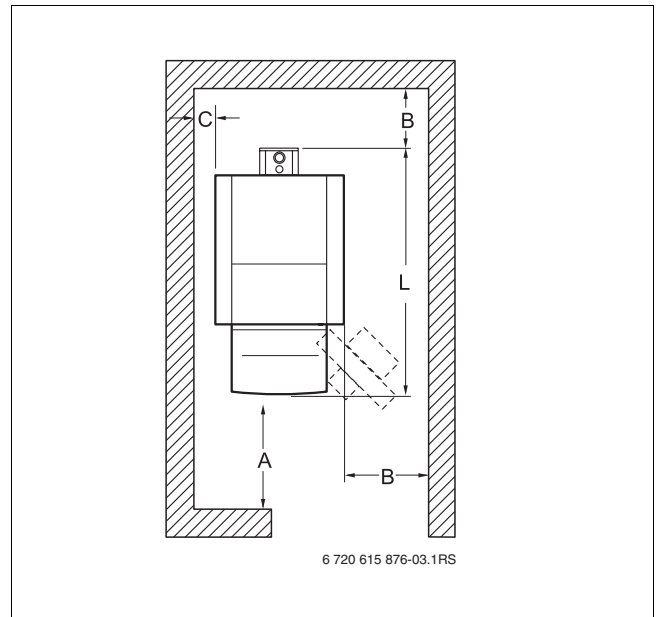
Distanze dalle pareti nel locale di posa (caldaia posizionata a destra o a sinistra)
